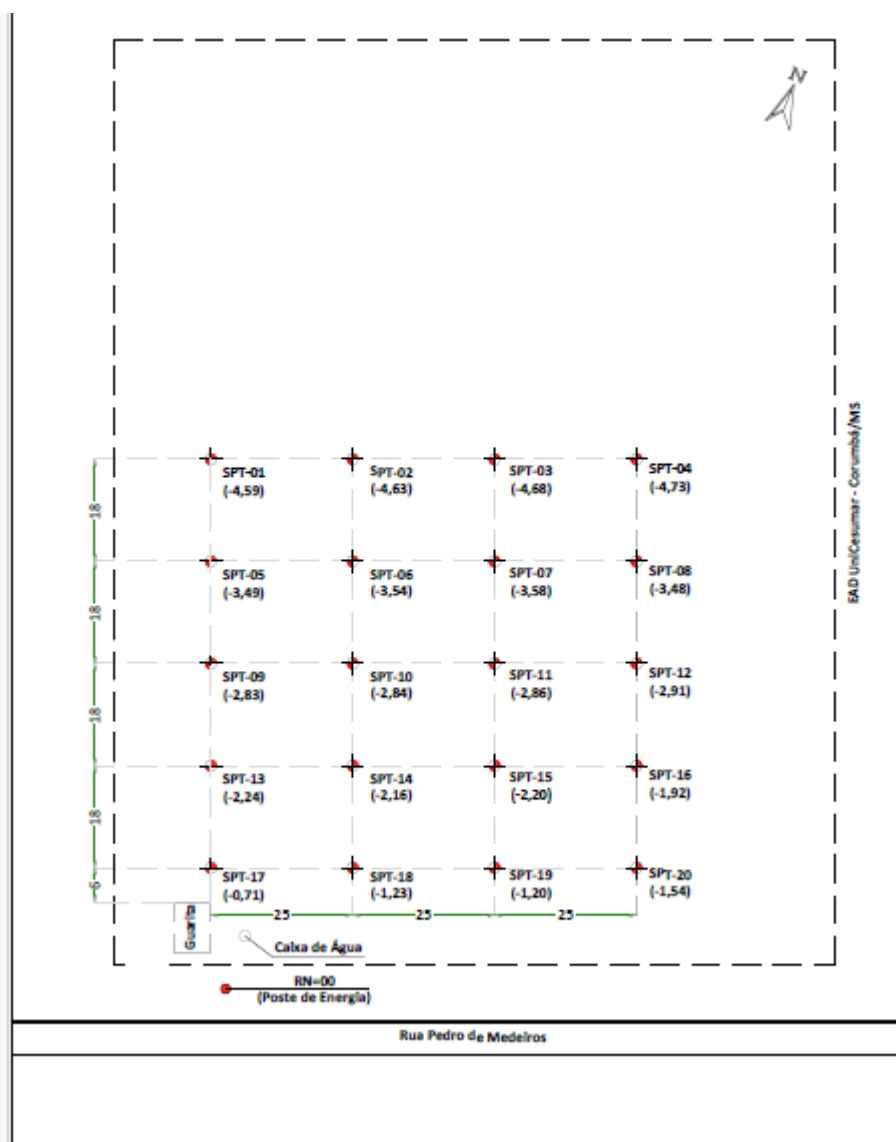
Croqui de Localização dos furos de sondagem executado na área.
